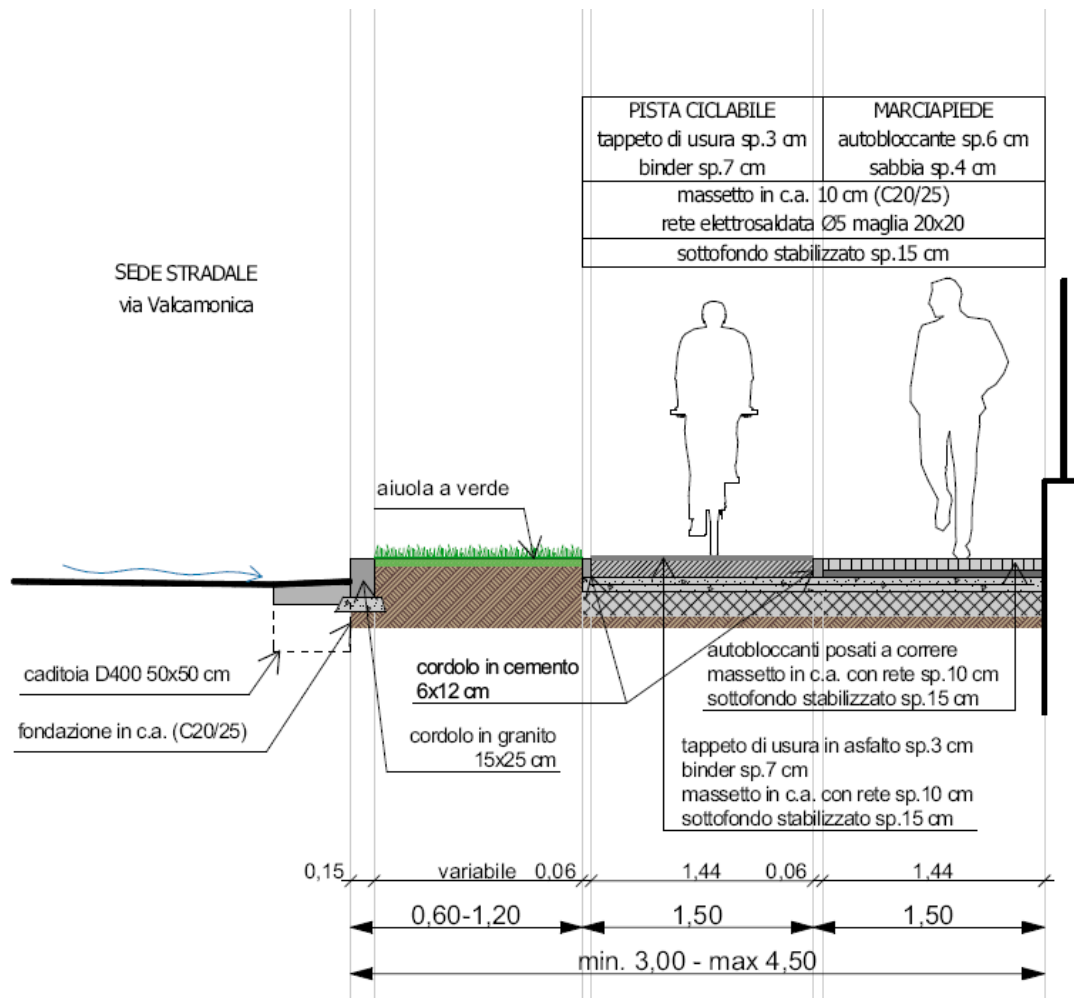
Estratto Tav. 6.10 - Dettagli
